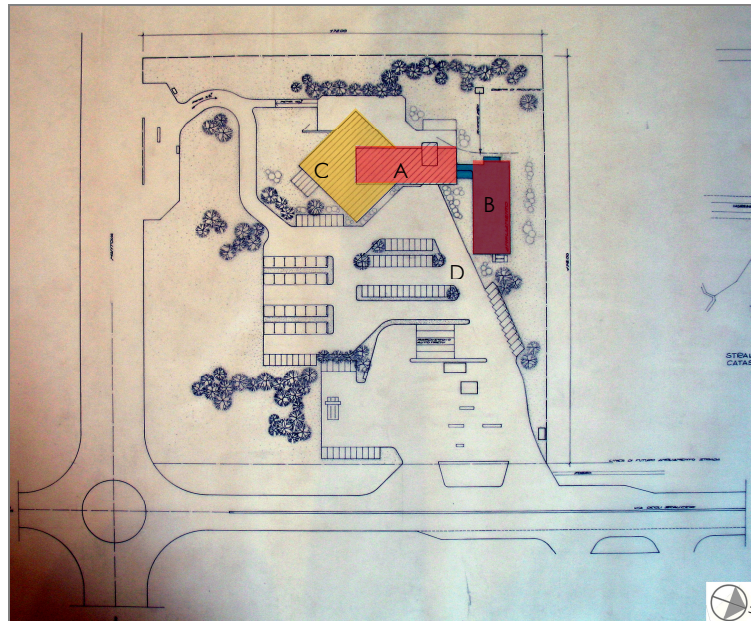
planimetria generale (fonte CSAC – stralcio tav. 1, archivio n. 400-1, rielaborazione f.m.)
